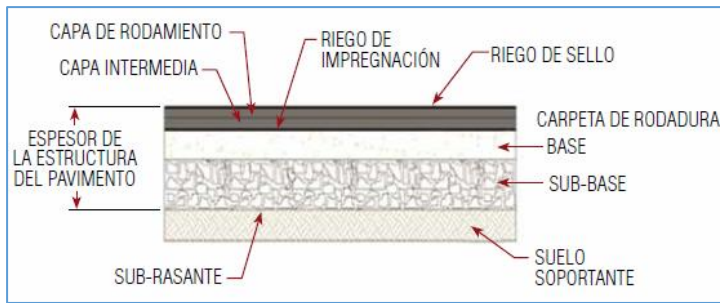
Estructura de un pavimento flexible. Fuente: DGIP [2]
